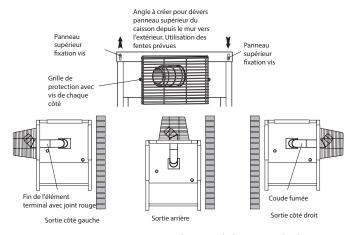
Fumisterie ventouse sortie horizontale basse standard
